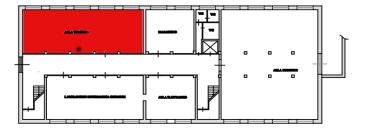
Pianta Edificio B - Sede Centrale - Posizione armadio rack
